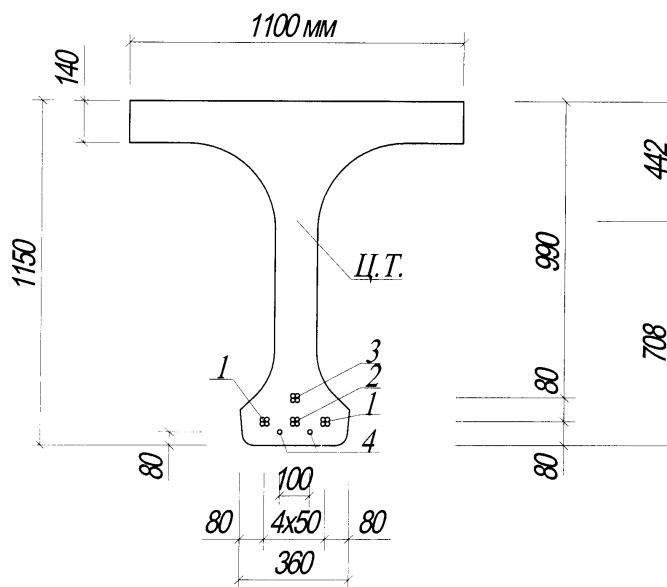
Поперечное сечение балки в середине пролета: 1÷3 – пучки напрягаемой арматуры; 4 – ненапрягаемая арматура
